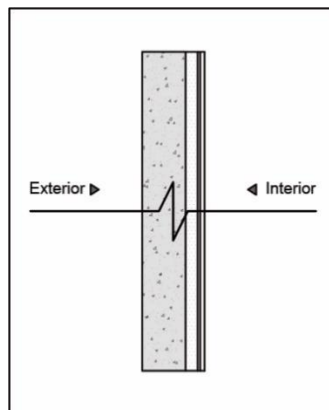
Sección esquemática sistema de aislamiento adosado al interior, elaboración propia.
